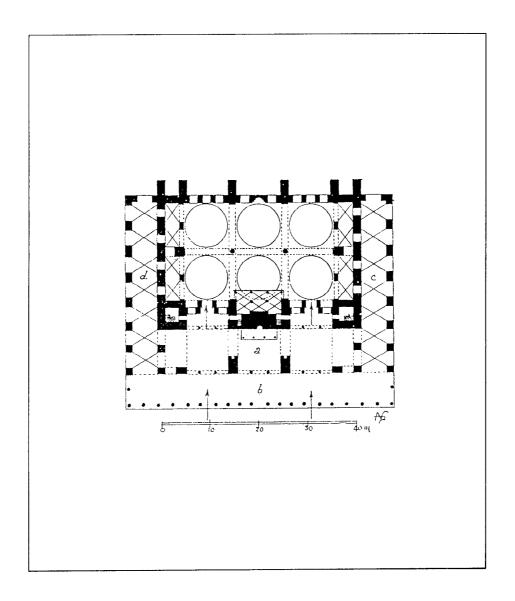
مسقط أفقي للمسجد العتيق أو القديم (اسكى جامع) في أدرنة (عن : ايفردى) .
